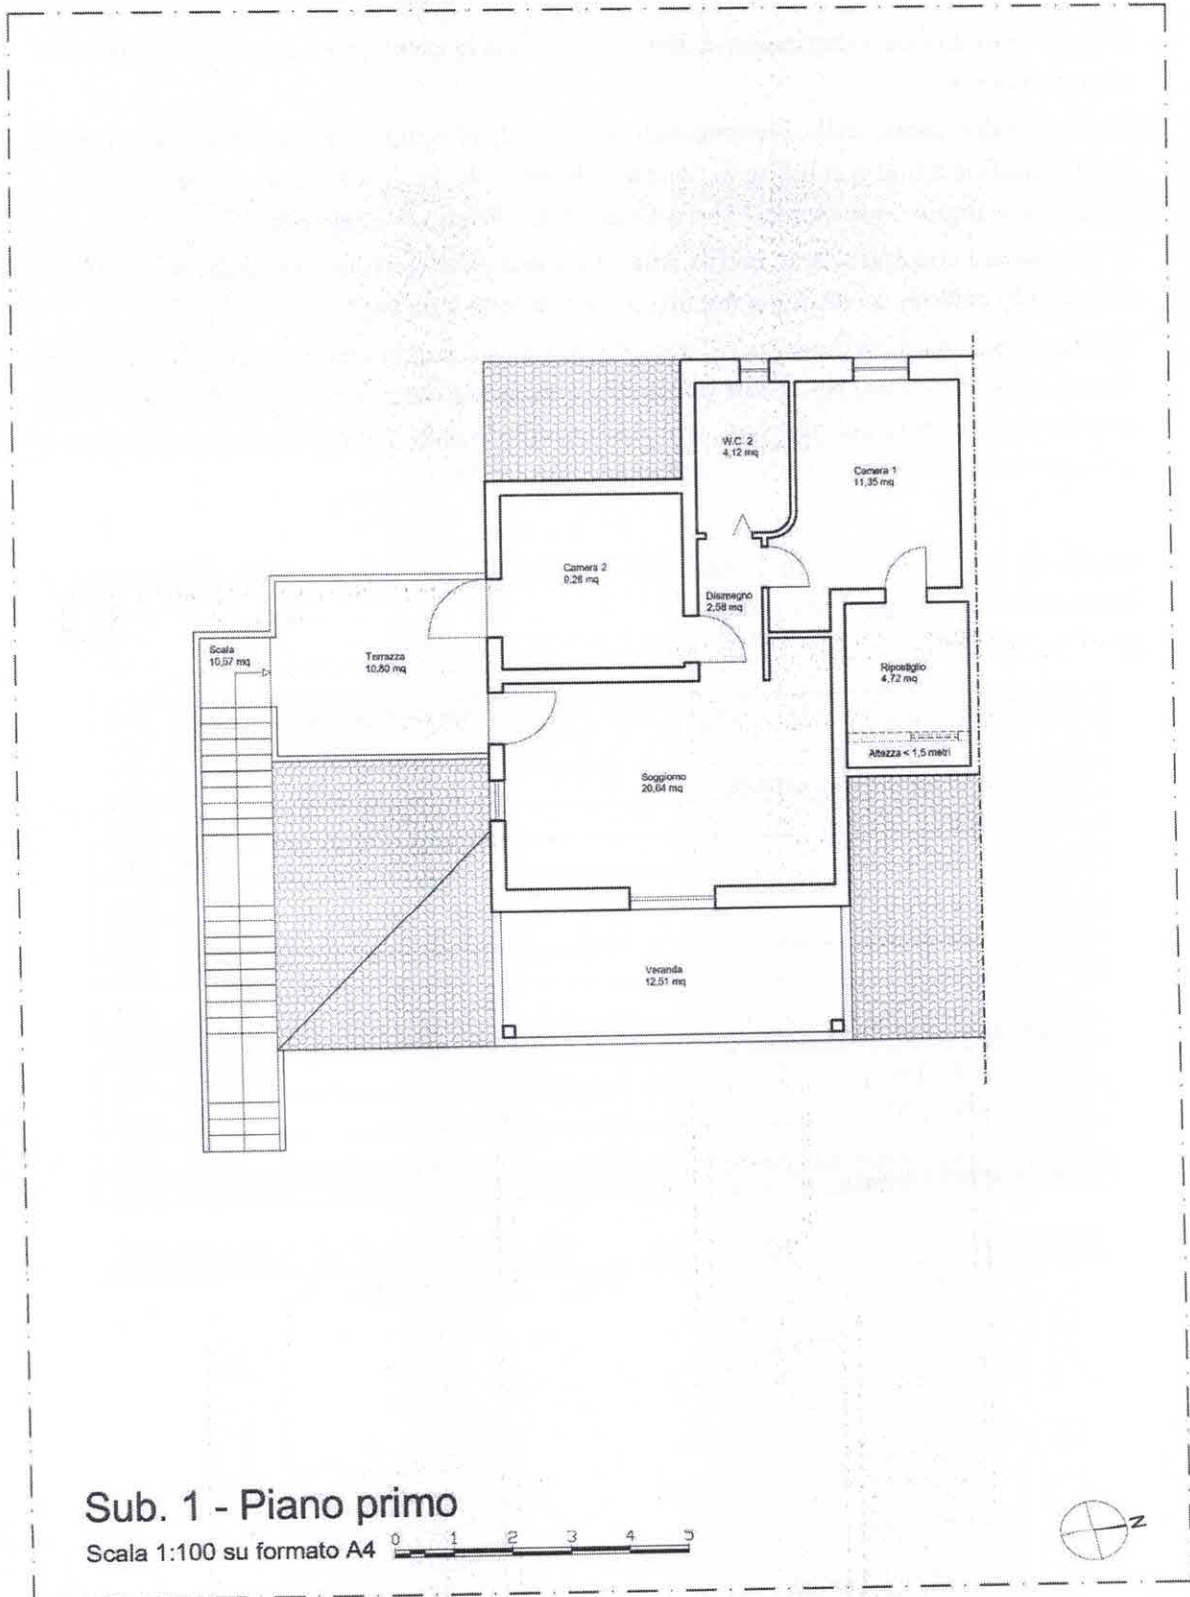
Subalterno 1 - Piano Primo - Planimetria dello stato di fatto rilevato
